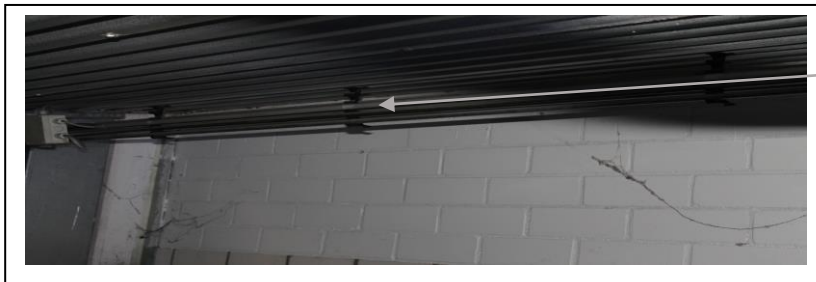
Feste Hydraulikringleitungen unterhalb eines Parksystems
